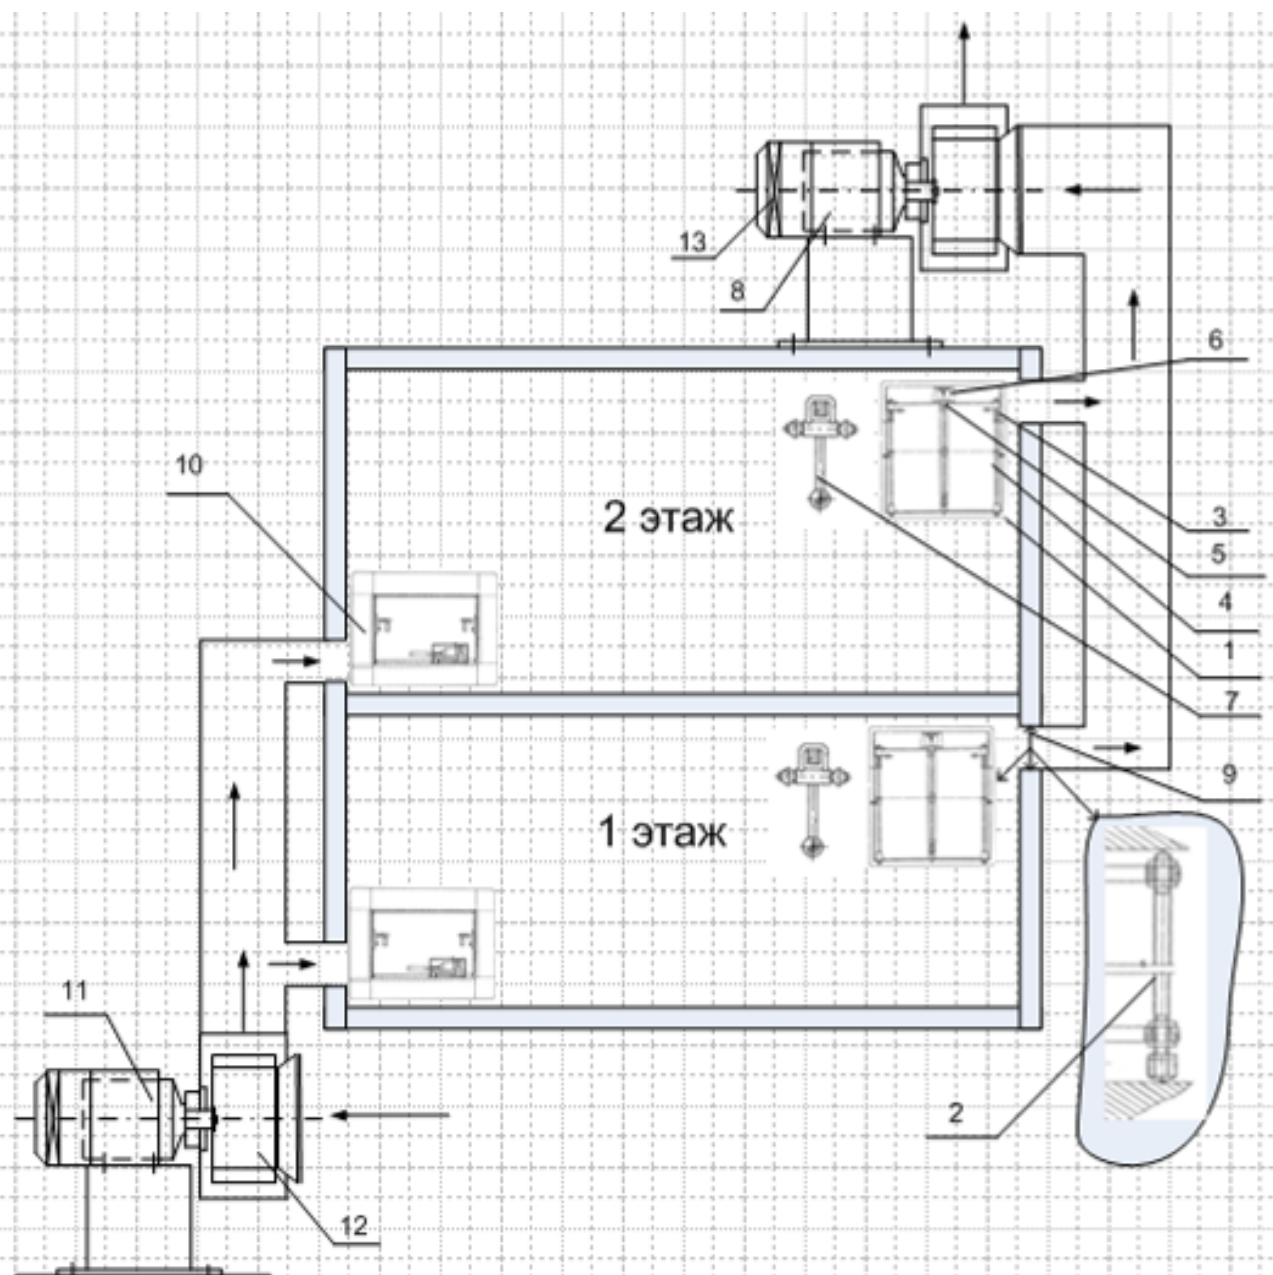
Устройство для удаления дыма из помещения на этажах здания через проемы в стене
